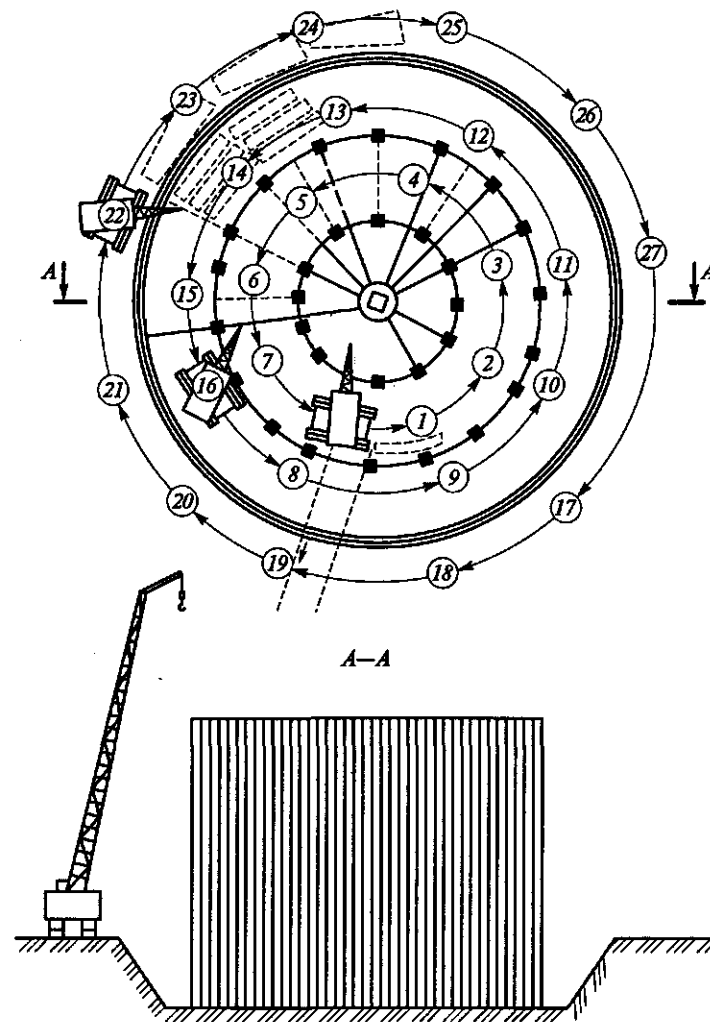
Монтаж конструкций железобетонного резервуара:
